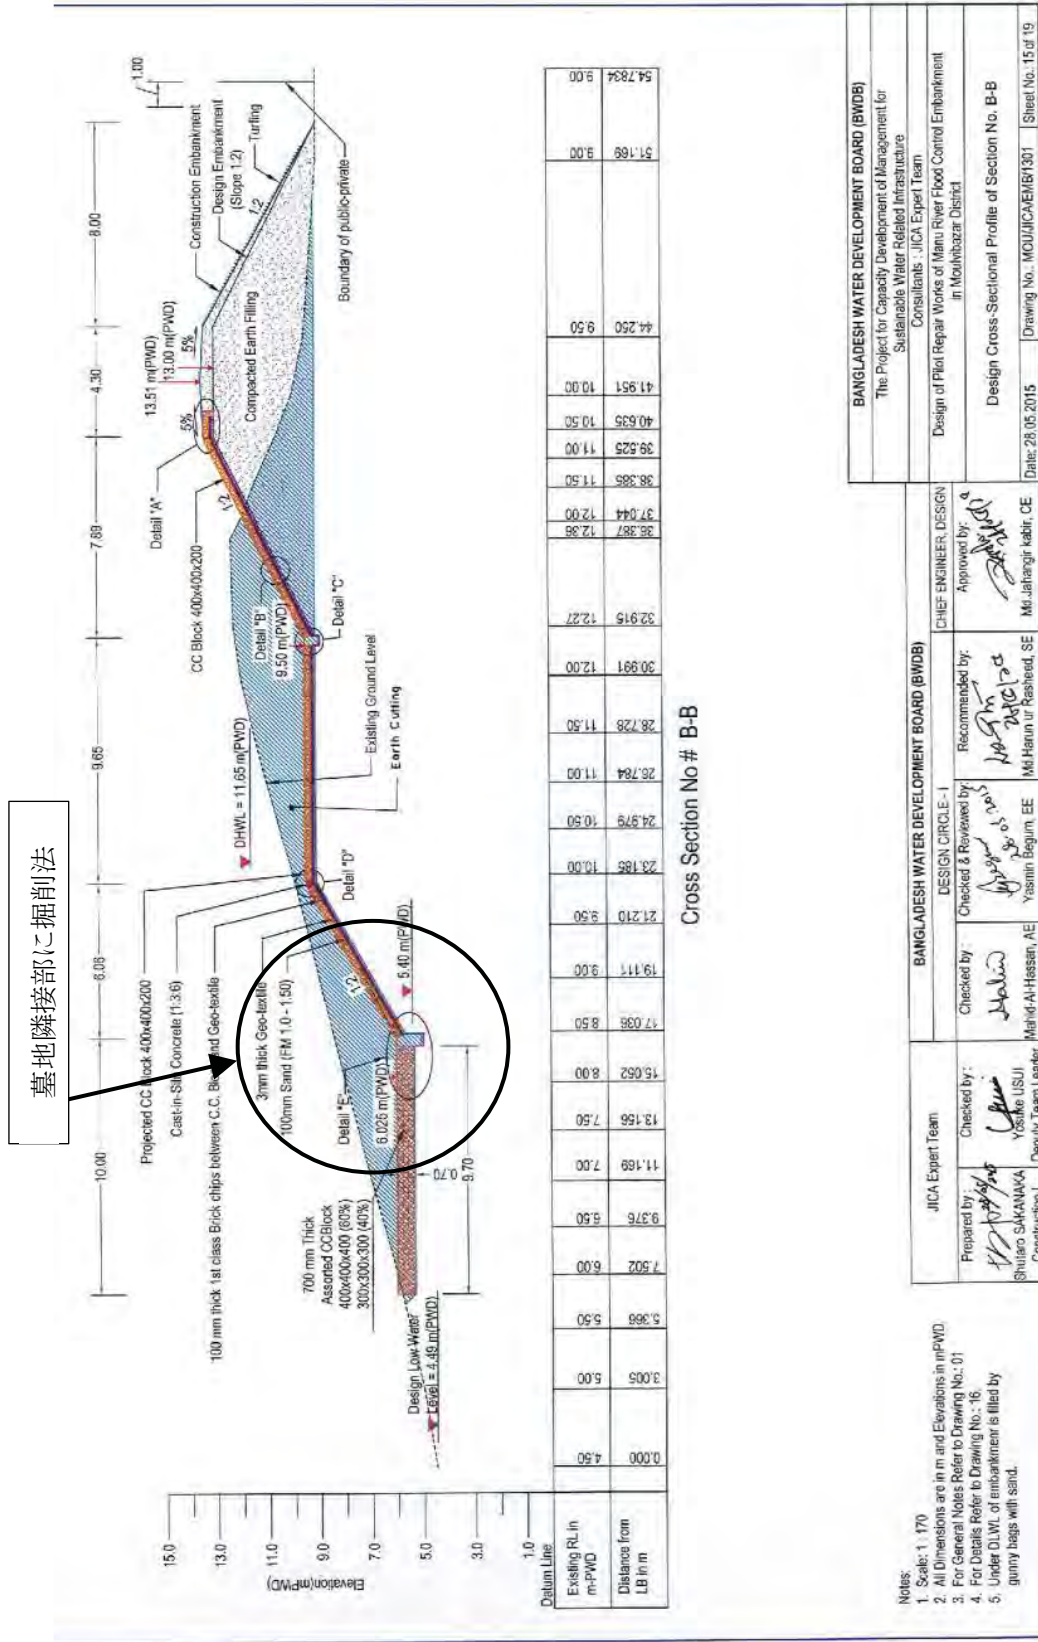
上流取り付け部 計画断面図 (当初設計 B-B 断面)
